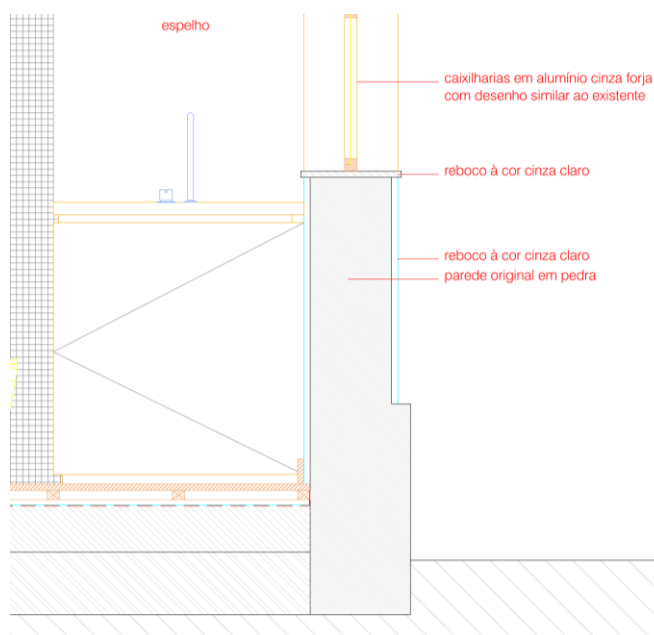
| Pormenor Construtivo Parede Existente, Garafim, Casa da Antiga Escola, Arq. André Rocha, 2020
